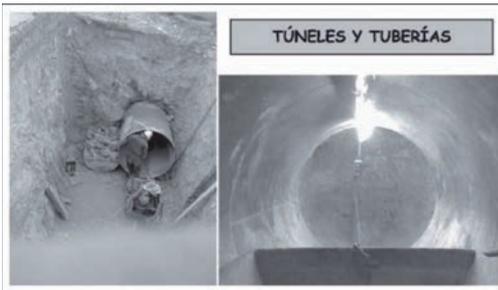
Detalle utilización en avance de túneles y galerías de pequeña sección.
